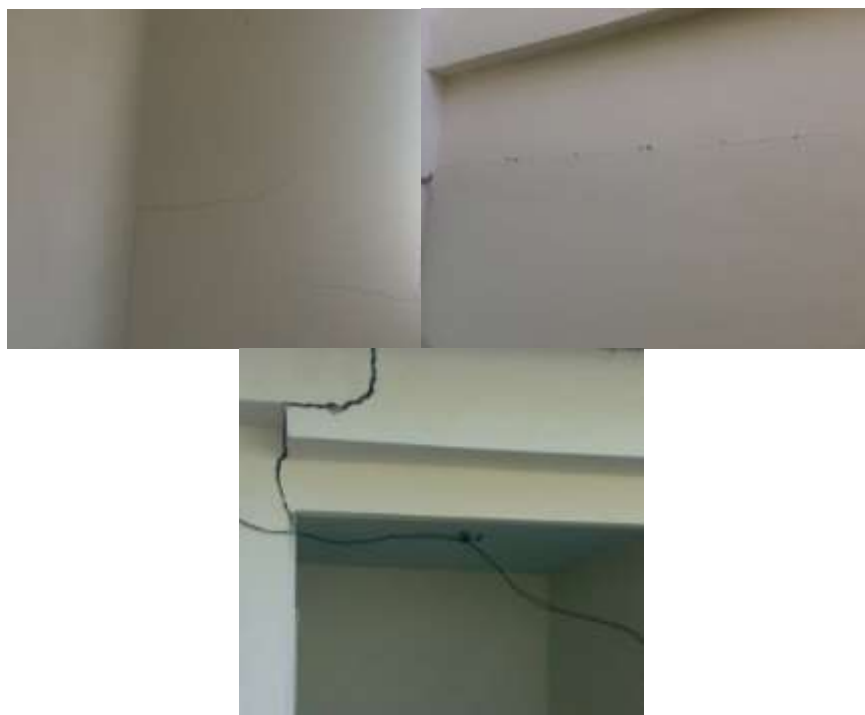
Fissuras inclinadas, horizontais e verticais em outros cômodos da edificação
